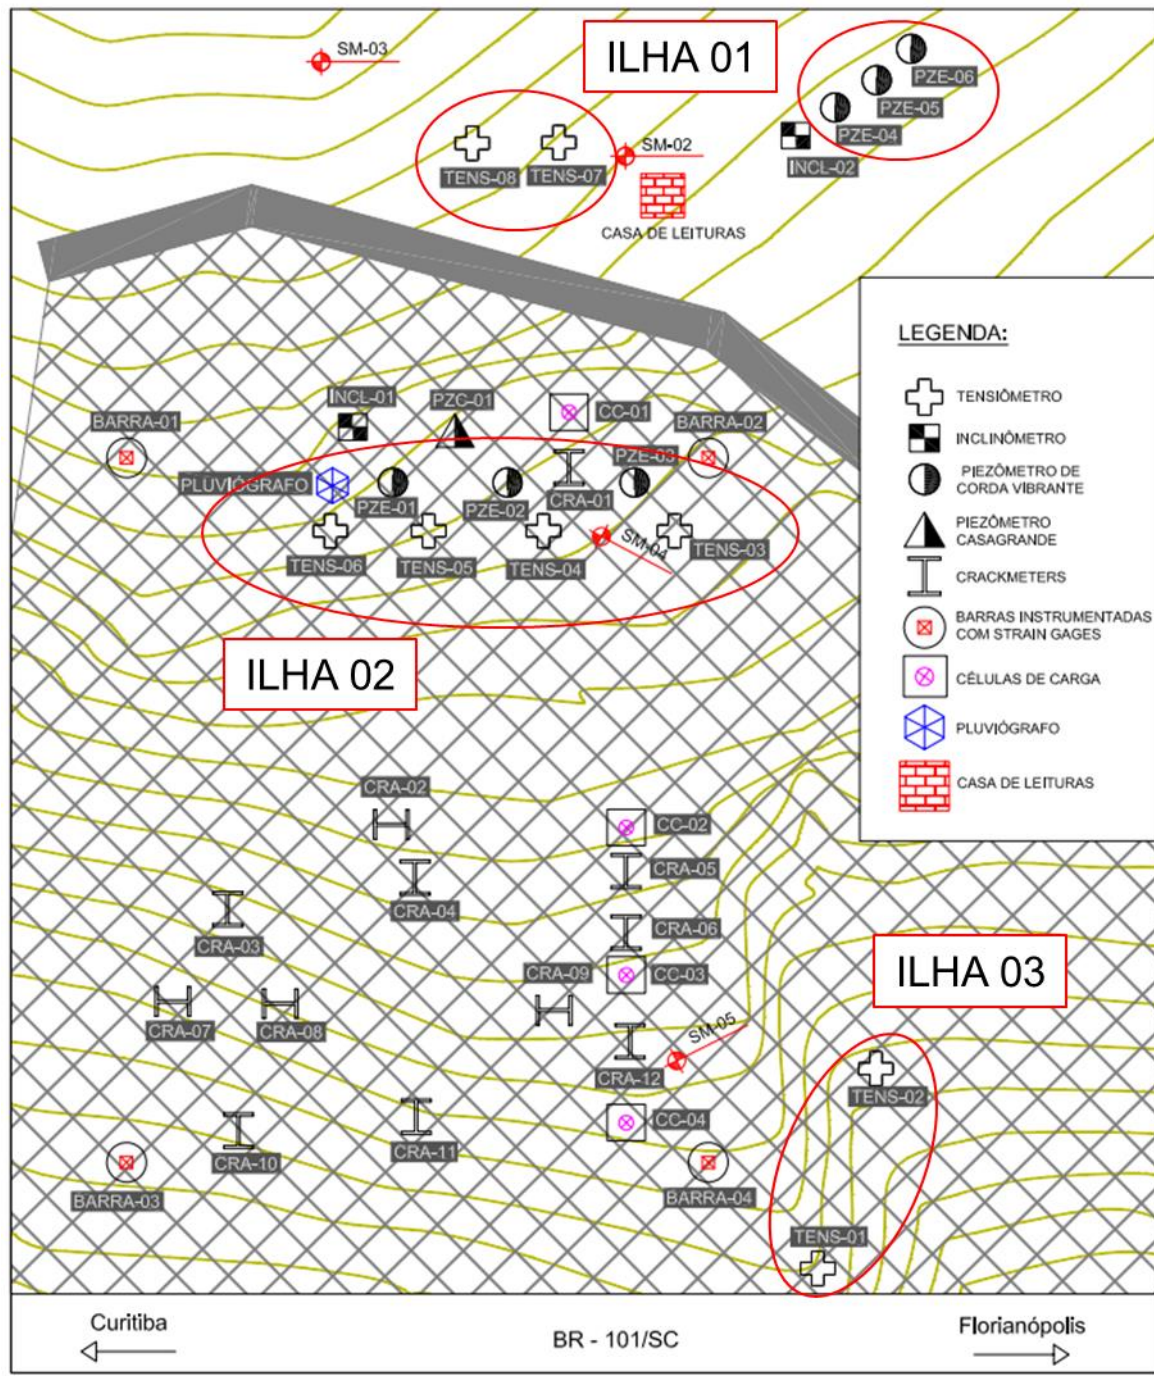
Croqui de instalação dos instrumentos em planta no Morro do Boi
